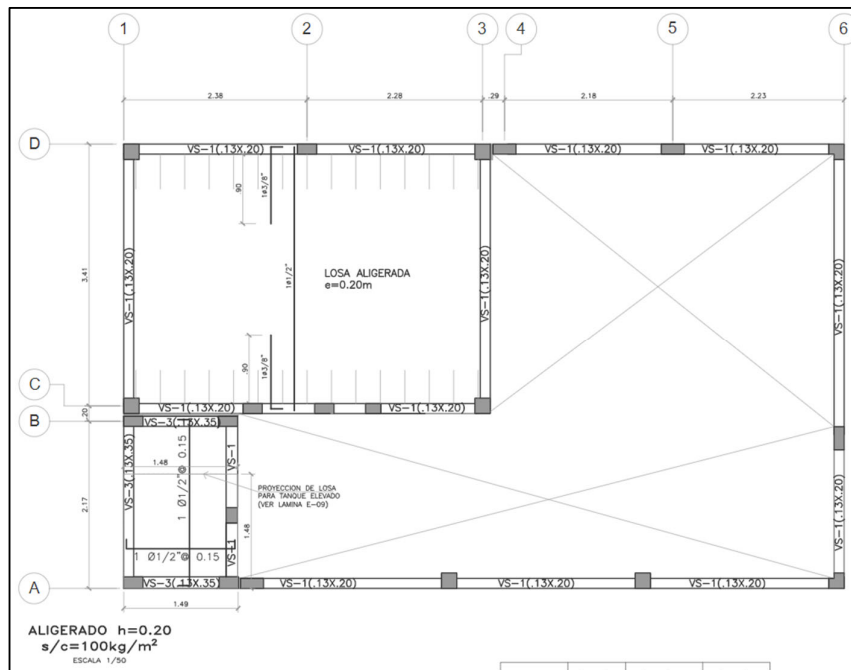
Plano de Planta de losa aligerada y losa maciza
